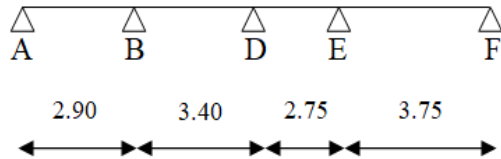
Schéma explicatif (types des poutrelles du plancher étage courant)
